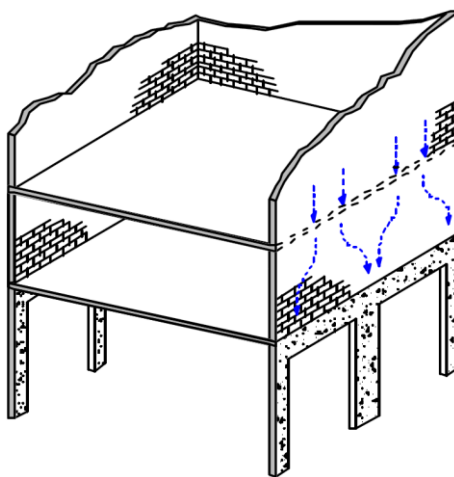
Edificação em alvenaria estrutural sobre pilotis em concreto armado. Fonte: Barbosa (2000).
